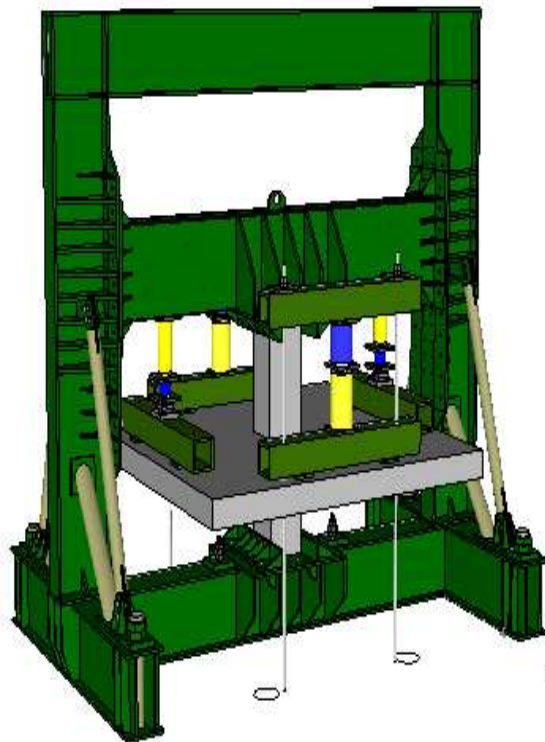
Vista em 3D do esquema de ensaio no pórtico metálico
